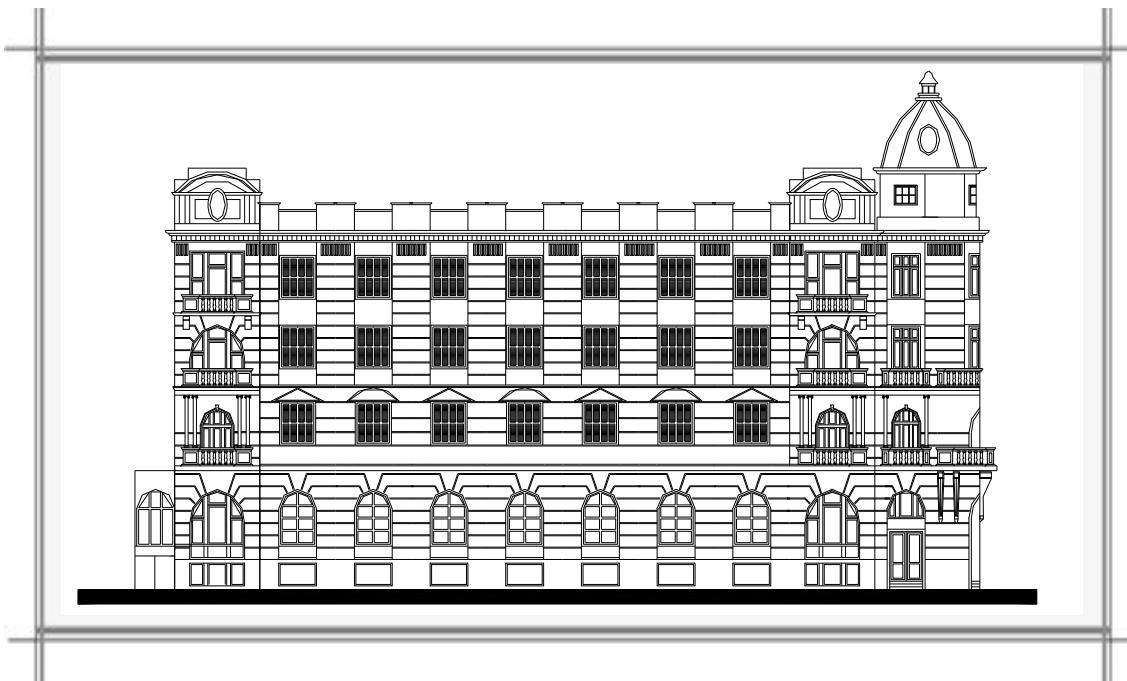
Fachada Rua Pe. Anchieta. Desenho: Cristiane Müller.
